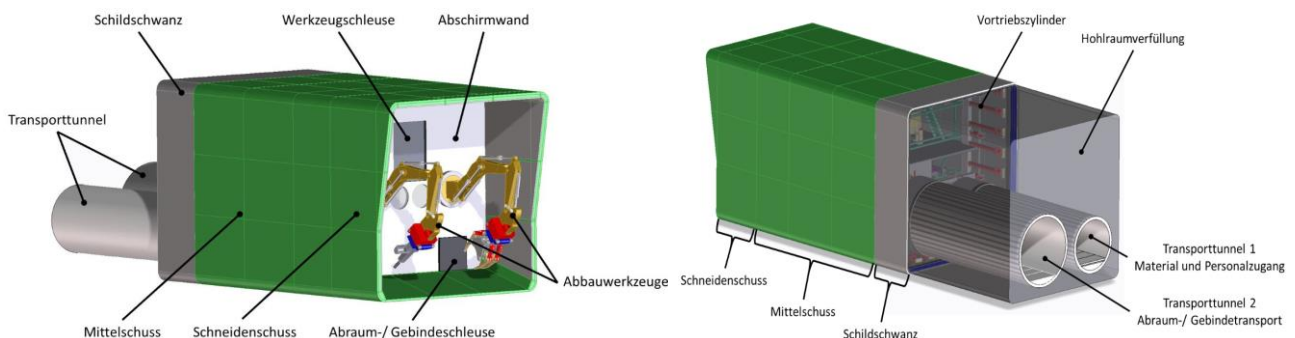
Schildmaschine mit Teilflächenabbau, Frontansicht (links), Rückansicht (rechts) [4]
